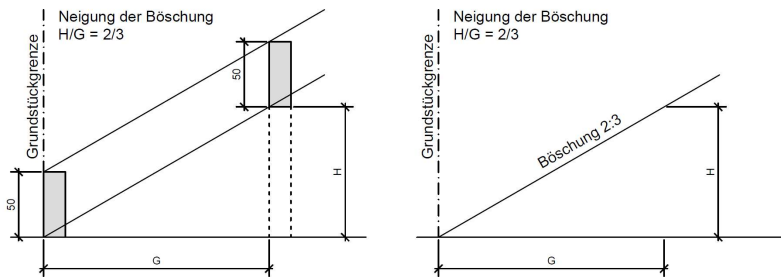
Terrinauffüllungen und Abgrabungen entlang öffentlicher Strassen
